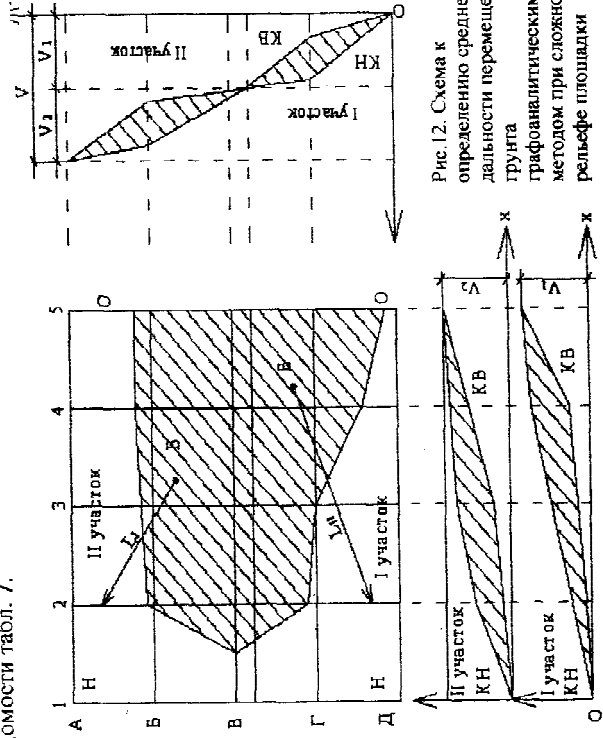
Схема к определению средней дальности перемещения грунта графическим методом при сложном рельефе площадки
